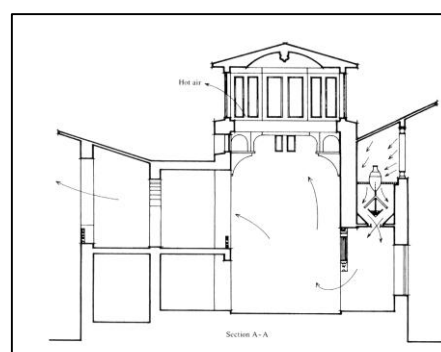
un exemple d'un Malqaf construit par Qaaf Muhib Al-Din Al-Shafi au Caire en Egypte (Bahadori et Dehghani-sanij, 2014)
